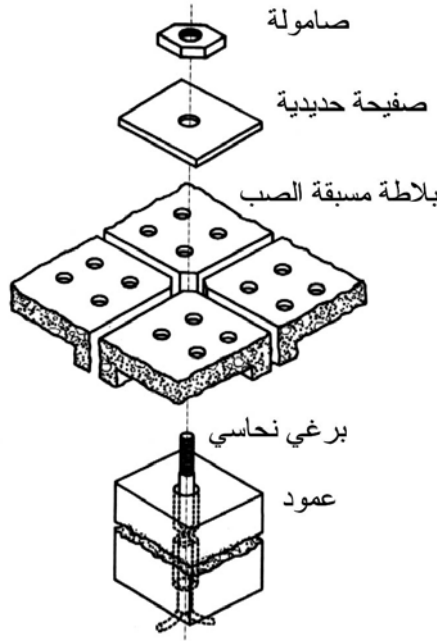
قاع المرشح إضافي مصطنع مكون من بلاطة مسبقة الصب مع رشاشات للغسيل العكسي
